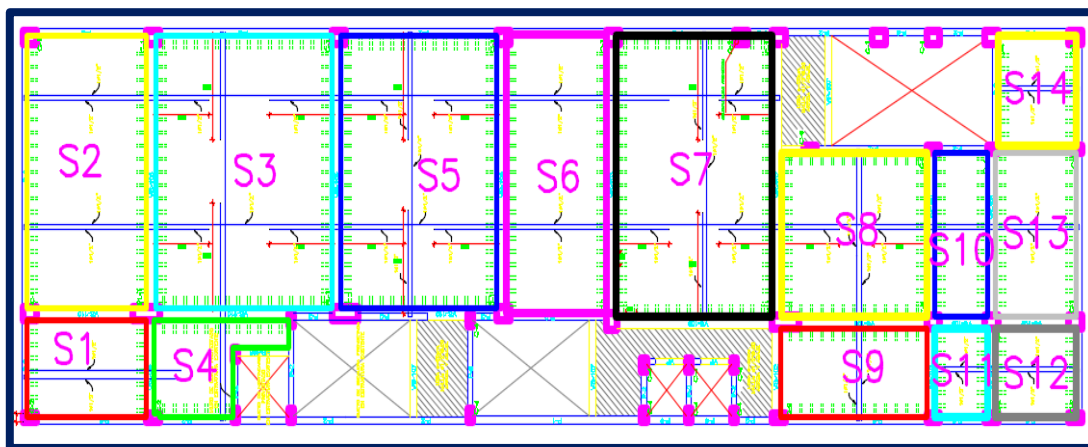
Sectorización de losa aligerada y losa en dos direcciones
